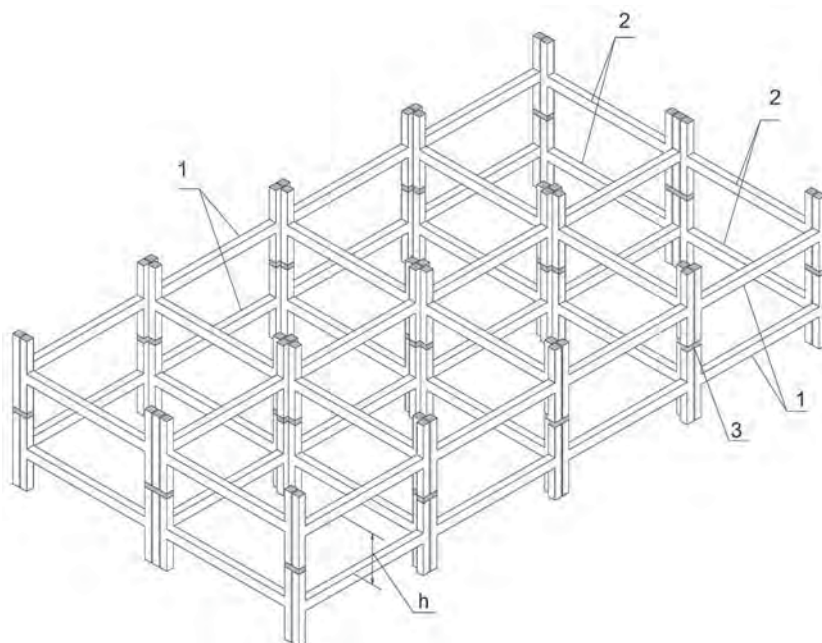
Схема одного этажа каркаса: 1 – рамы продольного направления; 2 – рамы поперечного направления; 3 – бетон омоноличивания; h – высота этажа
